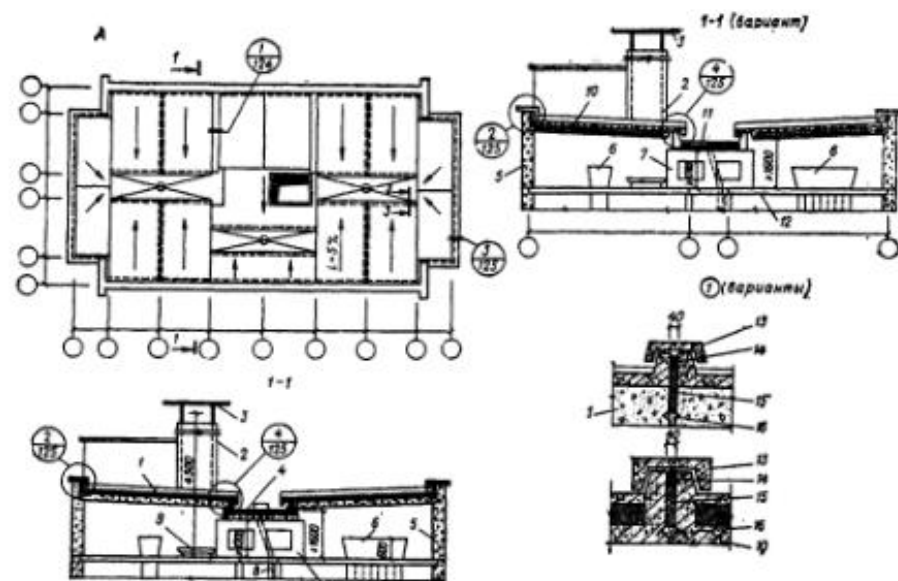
Рулонная крыша с теплым чердаком (тип В): А – схема-план крыши; 1 – вытяжная шахта; 2 – водосточная воронка; 3 – опорный элемент фризовой панели; 4 – фризловая панель; 5 – кровельная панель; 6 – лотковая панель; 7 – опорная рама; 8 – вентиляционная труба; 9 – утепляющий вкладыш; 10 – основная кровля; 11 – скользящая полоса рулонного материала; 12 – цементно-песчаный раствор
